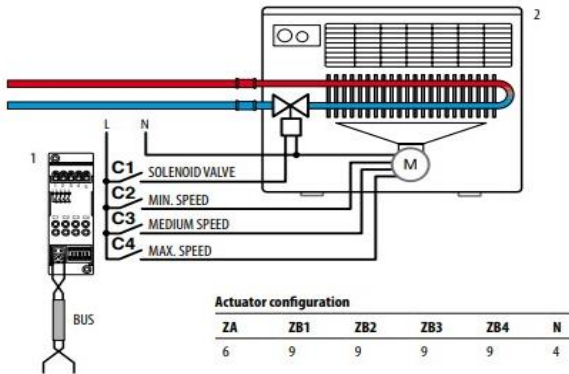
Схема керування фанкойлом або радіатором з високошвидкісним вентилятором
